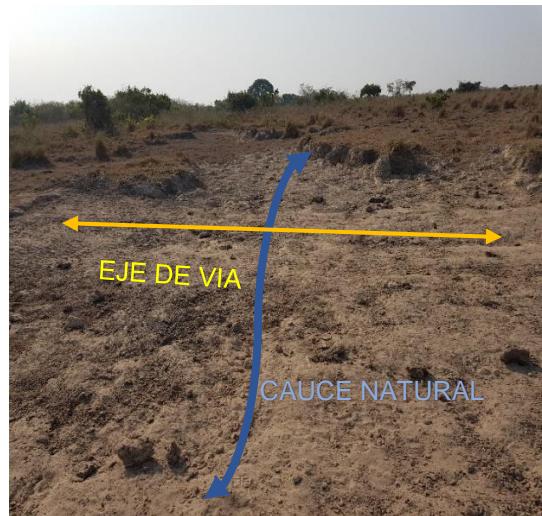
Estado actual para construcción de alcantarilla sencilla
